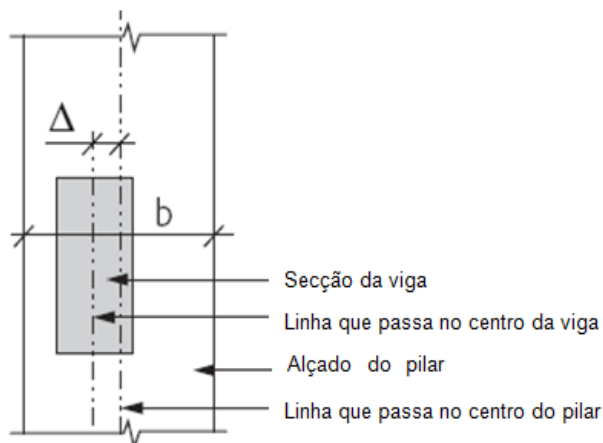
Desvio admissível para a posição duma ligação pilar/viga (adaptado de [15]).
